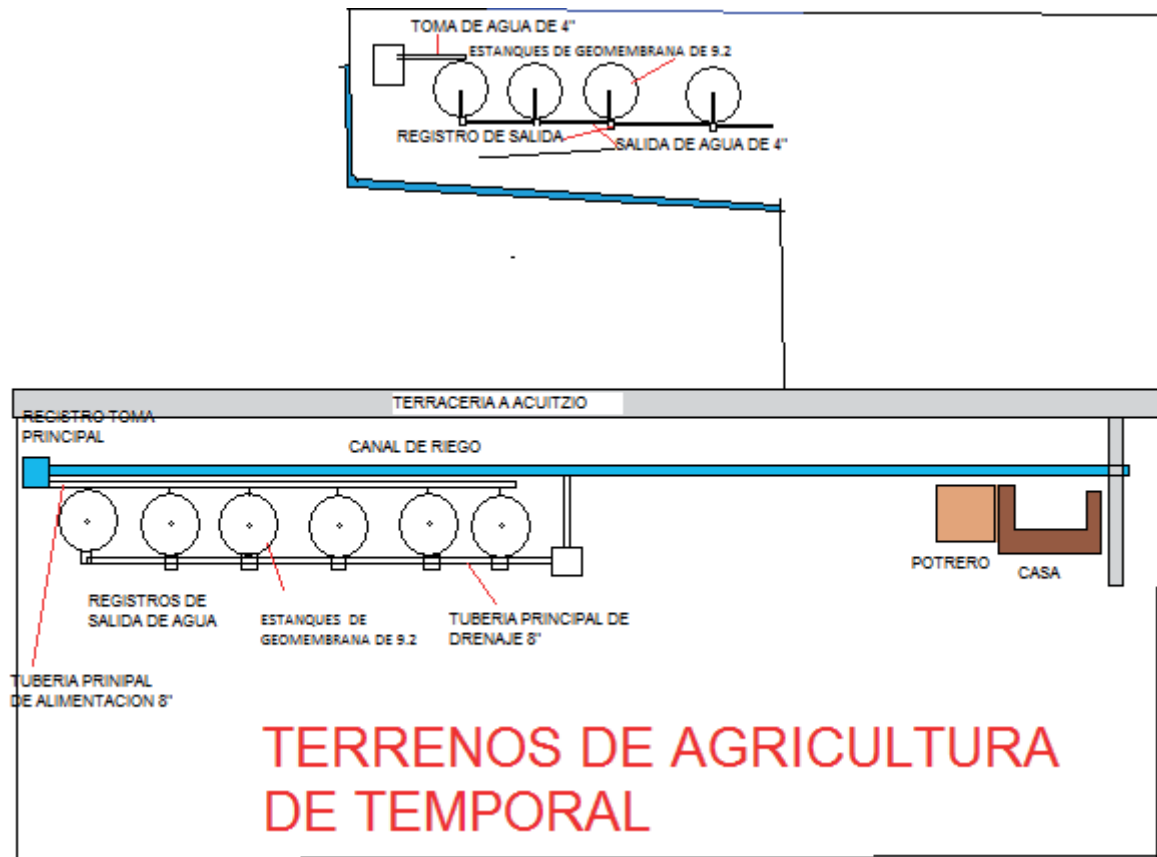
Croquis de la totalidad del equipo instalado en el terreno.
